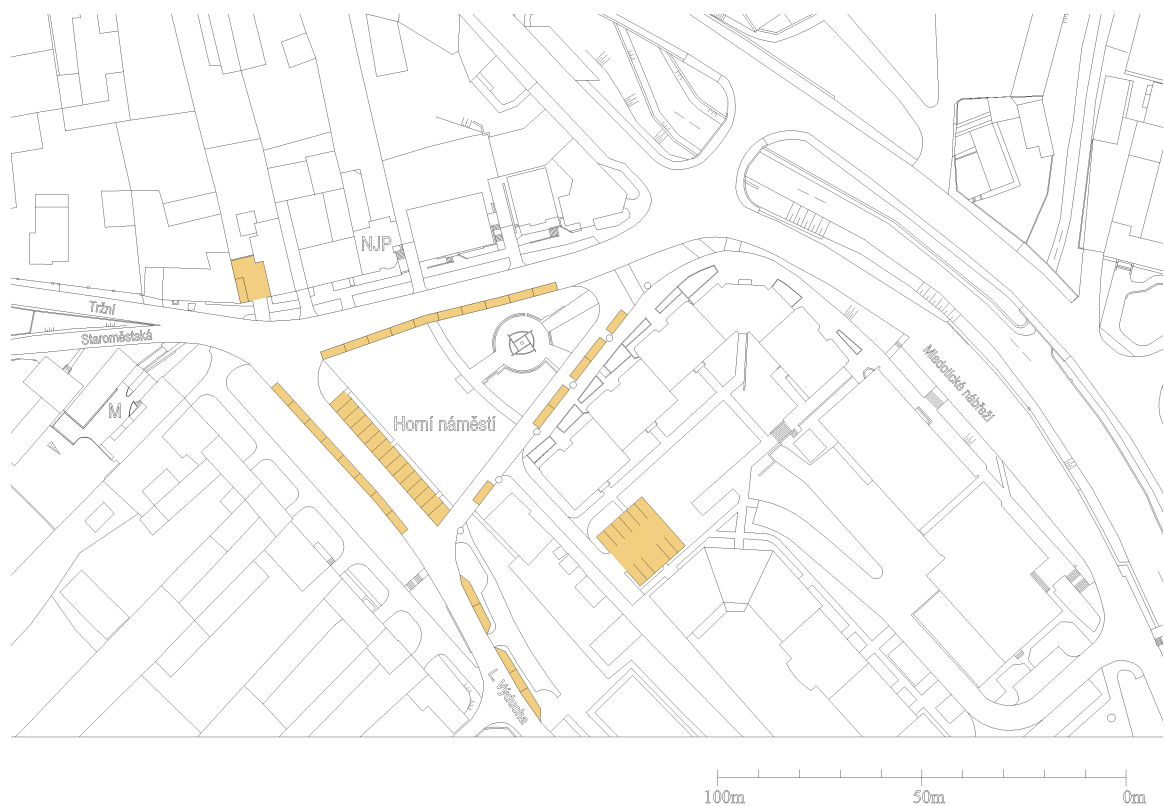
Horní náměstí a okolí, půdorys – současný stav.
